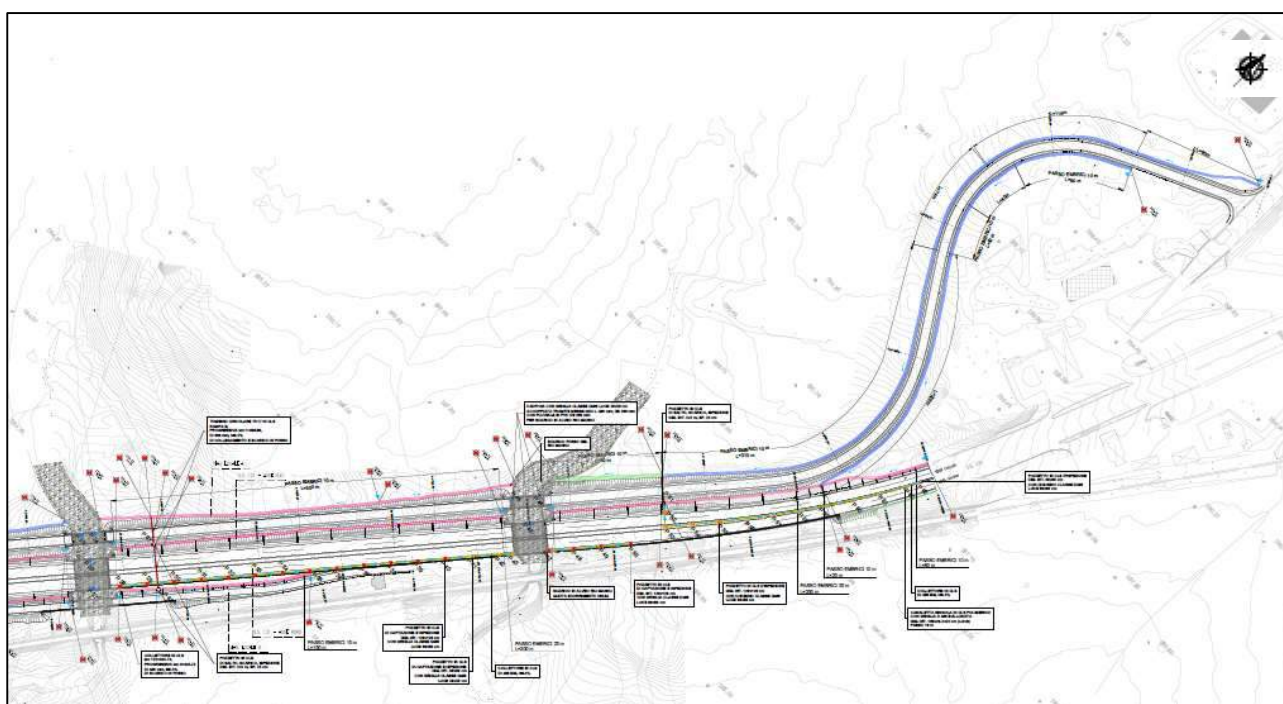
Stralcio planimetrico intervento S20-Risoluzione accessi al km 122+000, inquadramento 3/3
